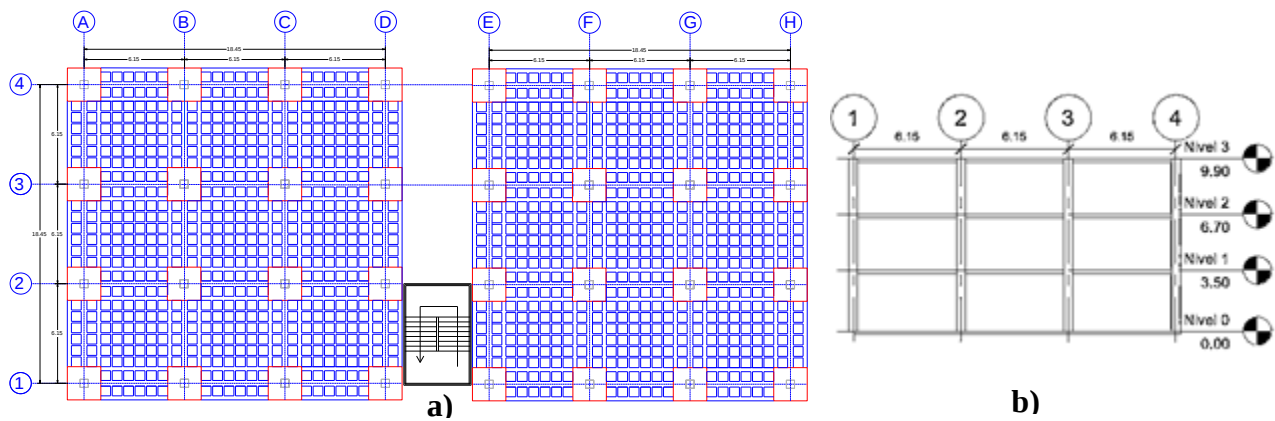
Edificios prototipos en estudio: a) vista en planta y b) vista en elevaciones.
